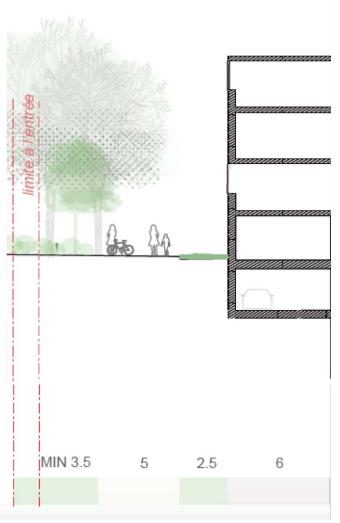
coupe de principe 4 : cheminement MD et continuité paysagère sur le front nord, vers la placette
